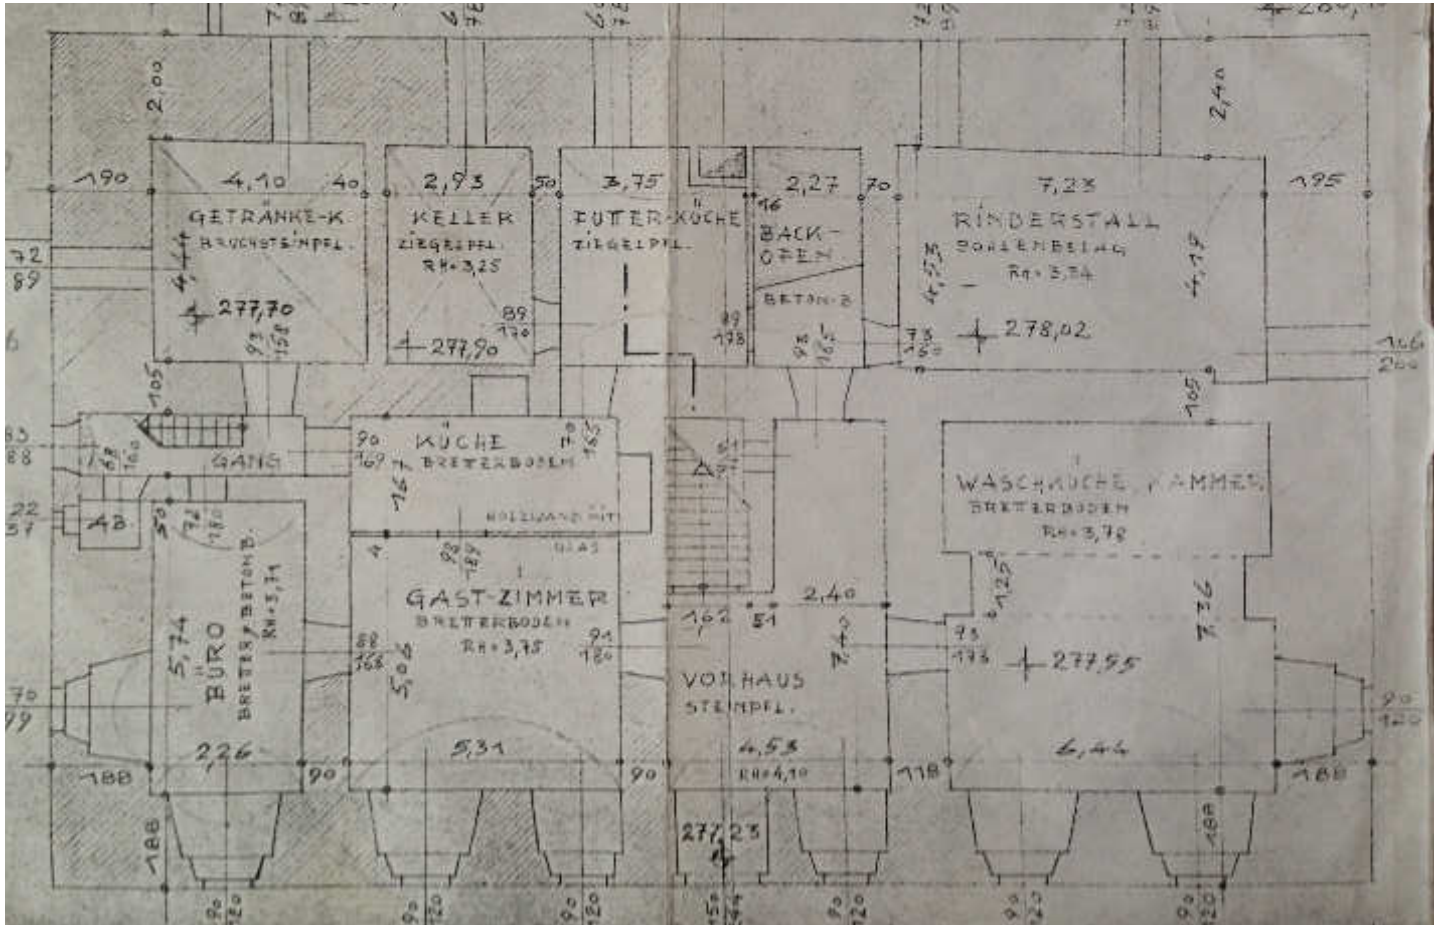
Bestandsplan 1959 - Grundriss Erdgeschoss
